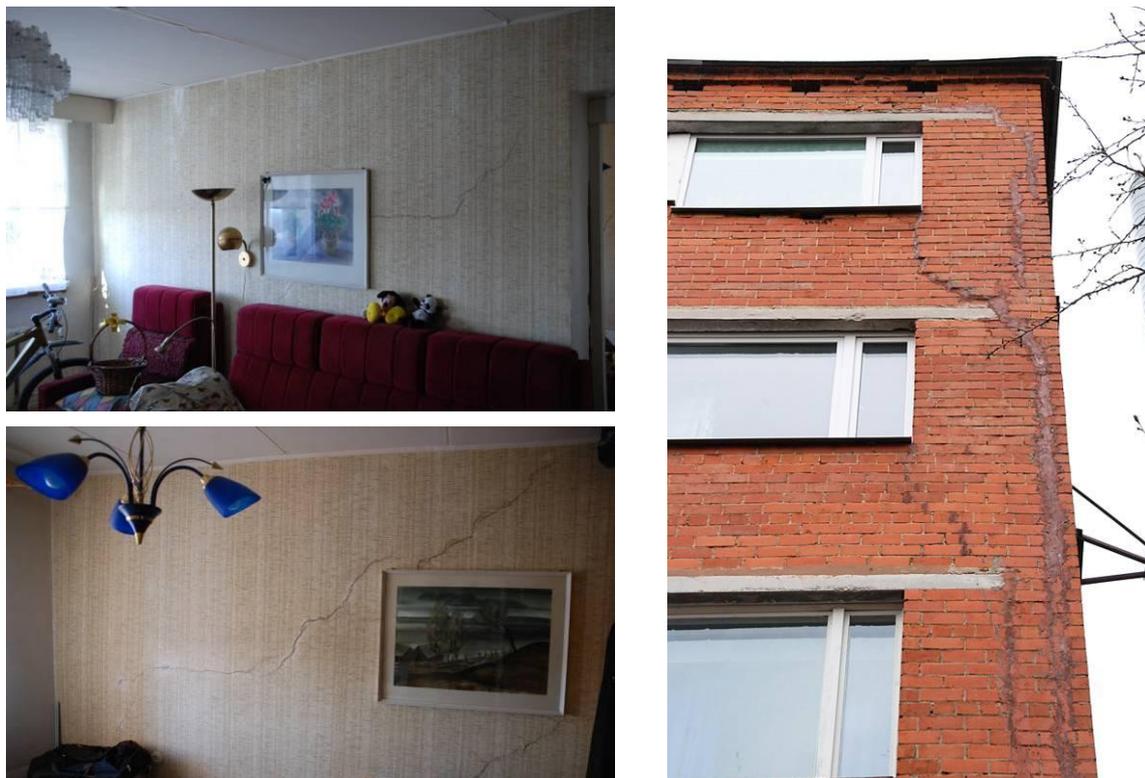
Поперечная трещина на несущей стене здания (слева) и трещина на торцевой стене (справа), которые вызваны просадкой фундамента и плохим качеством кладки.
